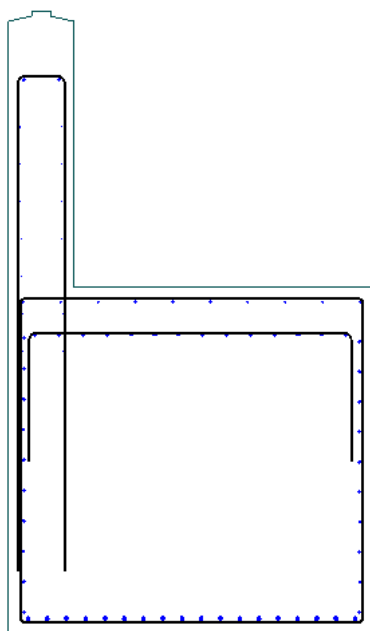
Corte transversal da travessa TR1 utilizado para modelagem das armações.
